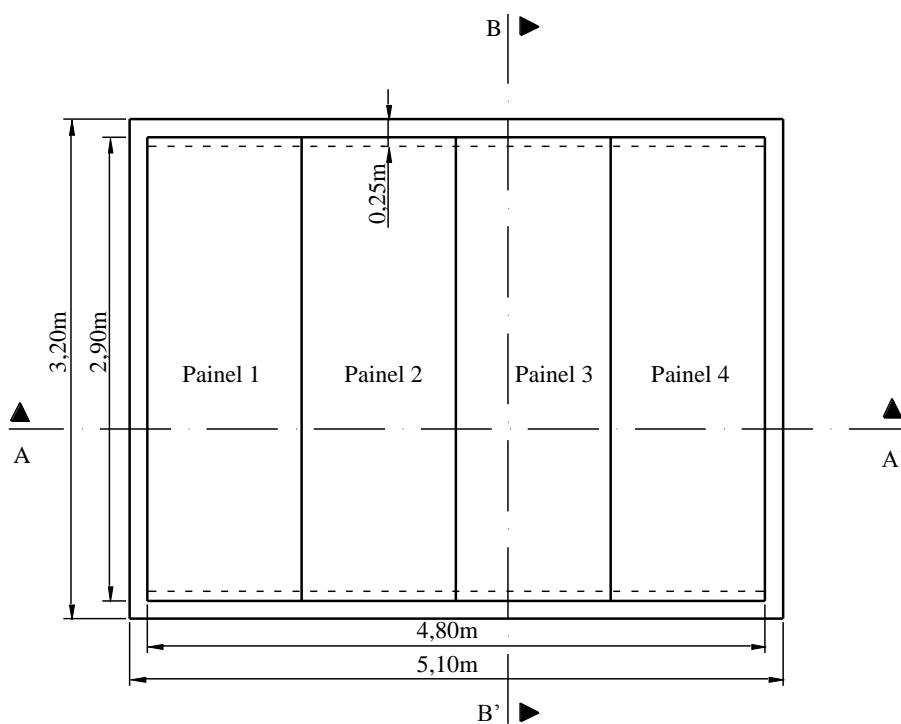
Esquema do modelo de ensaio com quatro painéis em planta utilizado por Martins [4].
